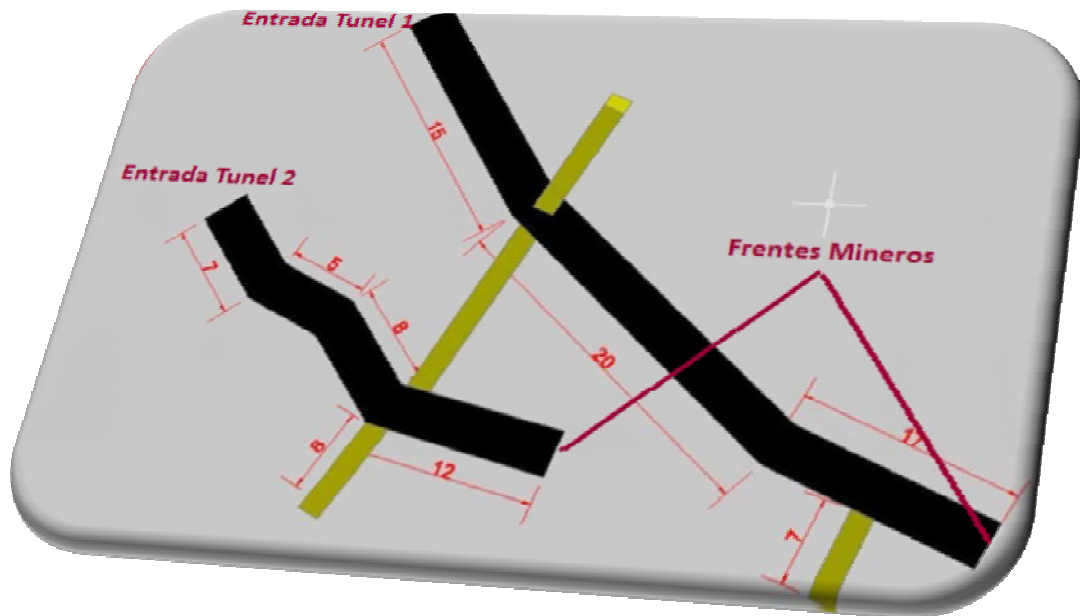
Vista en planta de los túneles 1 y 2 (ACAD 2008). En amarillo los inclinados y en negro los túneles principales
